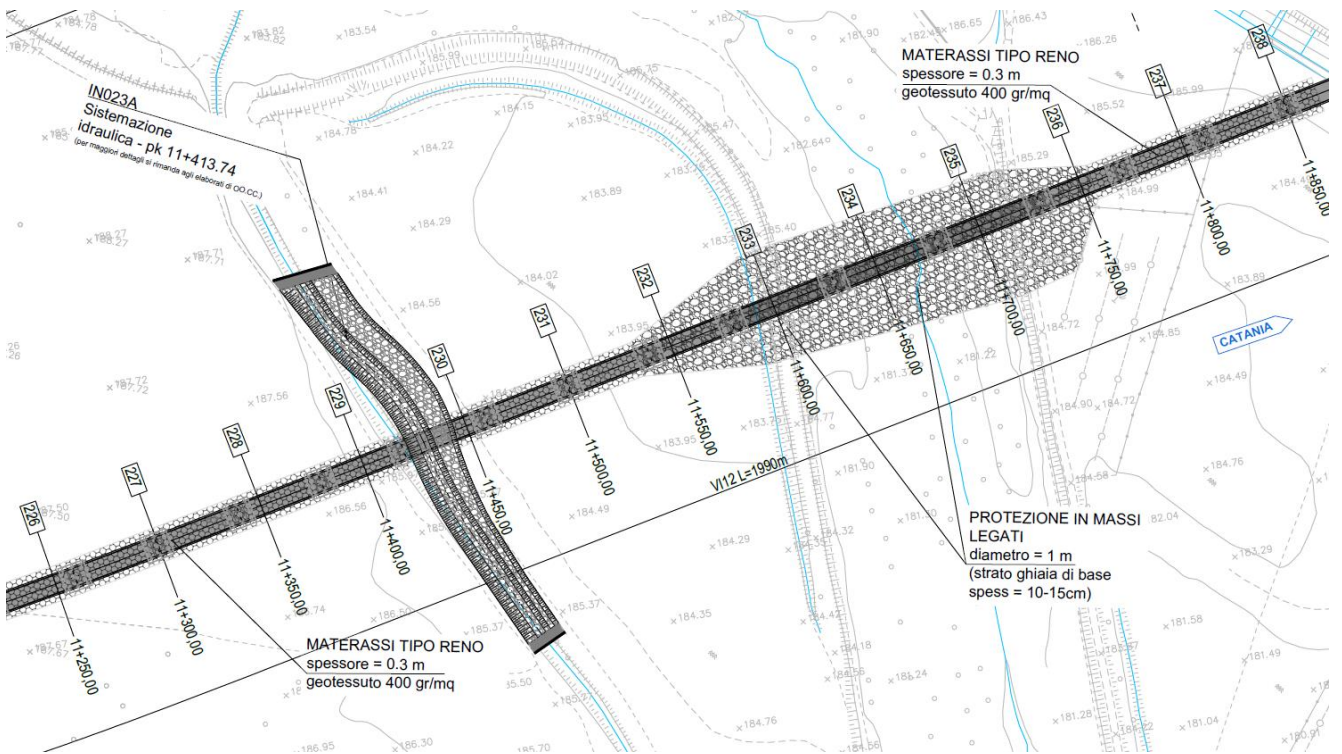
Viadotto VI12: stralcio della planimetria delle opere di sistemazione idraulica.
